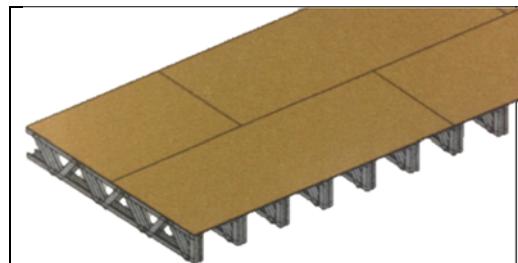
Exemplo placas de OSB sobre as treliças metálicas – destaque juntas desencontradas
